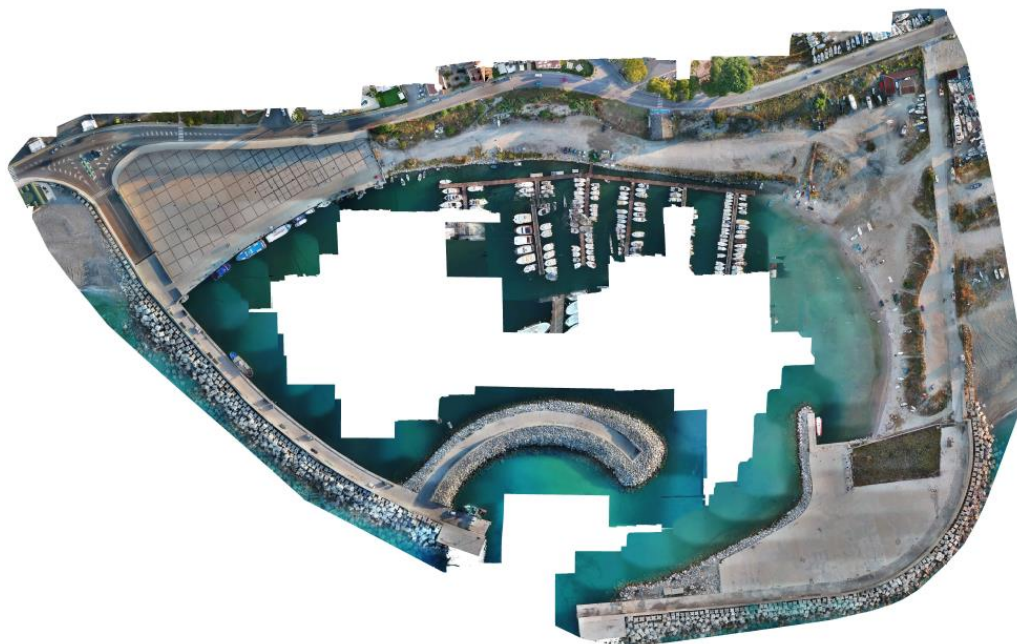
Vista aerea dell'area (ortofoto di dettaglio estratto elaborato A16)
